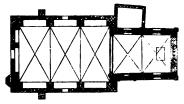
Gustow, Kirche, Grundriss, 1:667.
